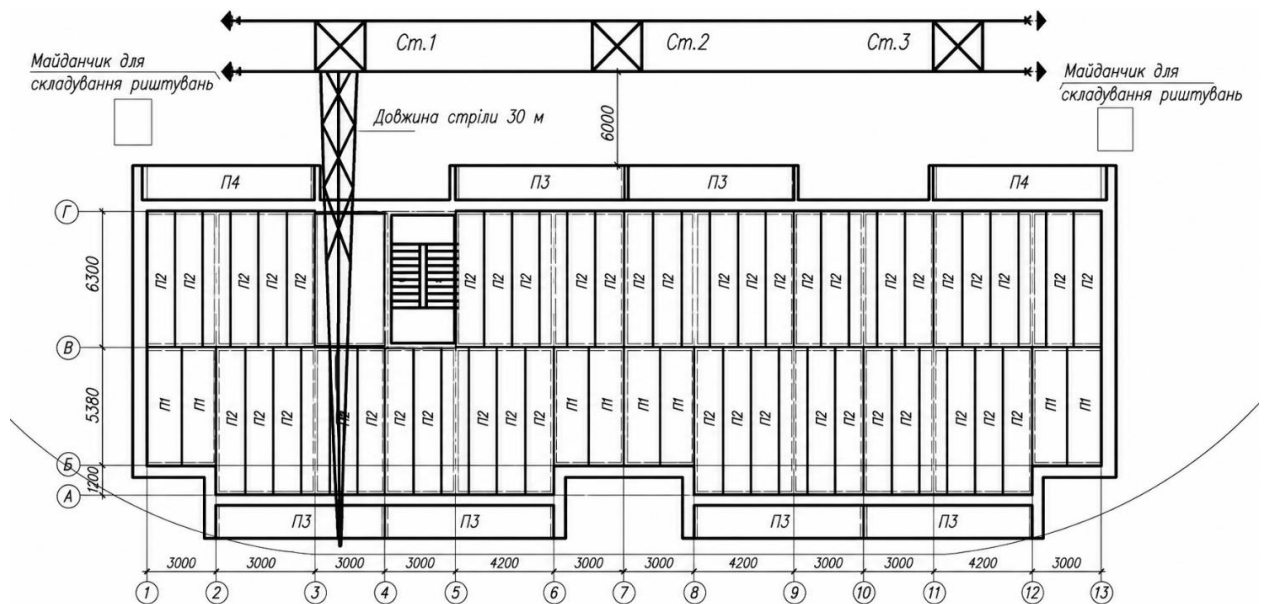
Схема монтажу плит перекриття баштовим краном
